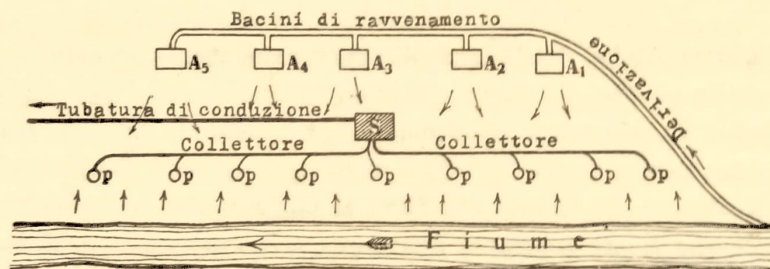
Schema di ravvenamento secondo DEBAUVE e IMBEAUX. Planimetria.
